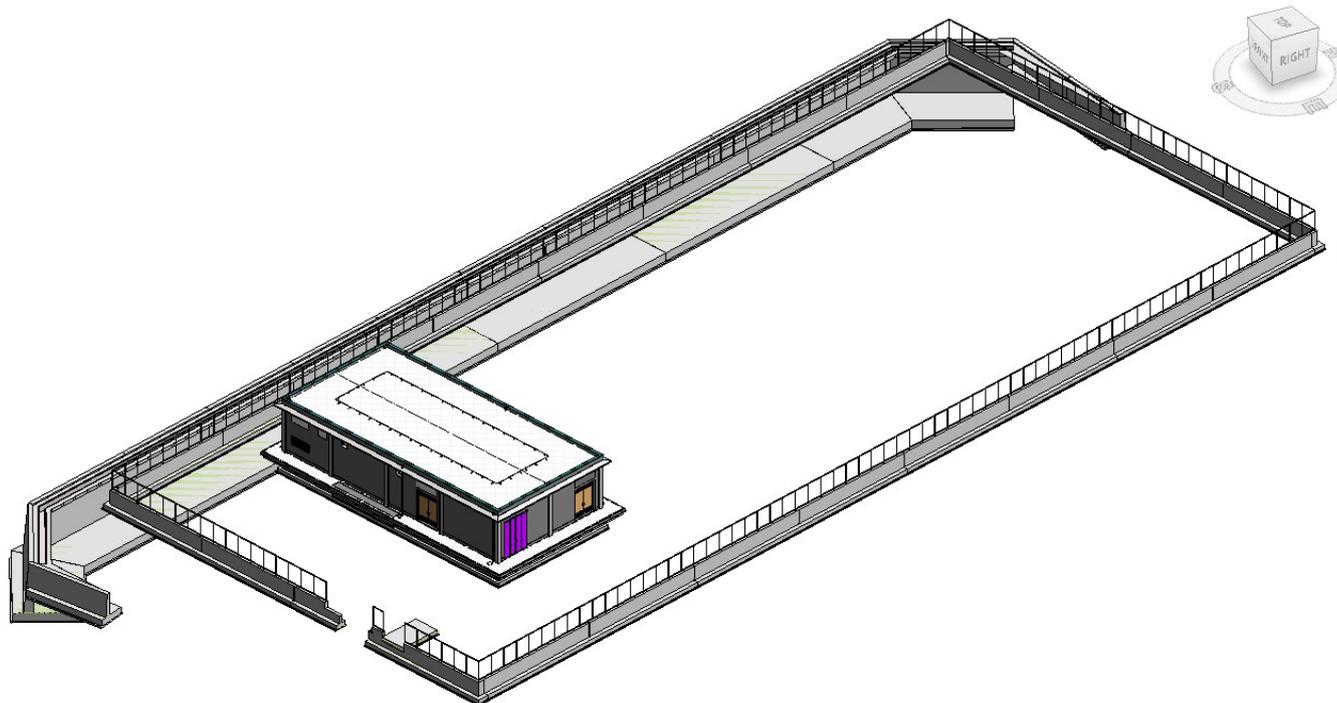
Modello tridimensionale estratto da Revit per il piazzale RI12
